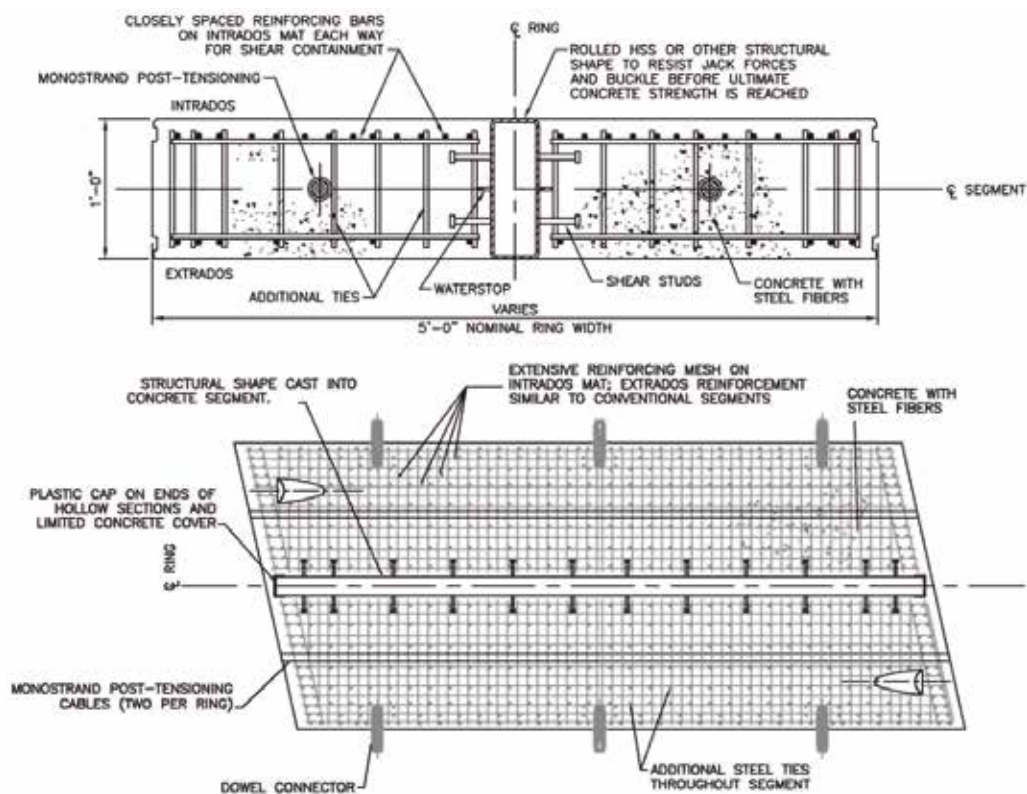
Anillos de dovelas prefabricadas de hormigón armado especiales (post-tesado, malla electrosoldada en intradós y elementos de contracción mediante perfiles de acero)
